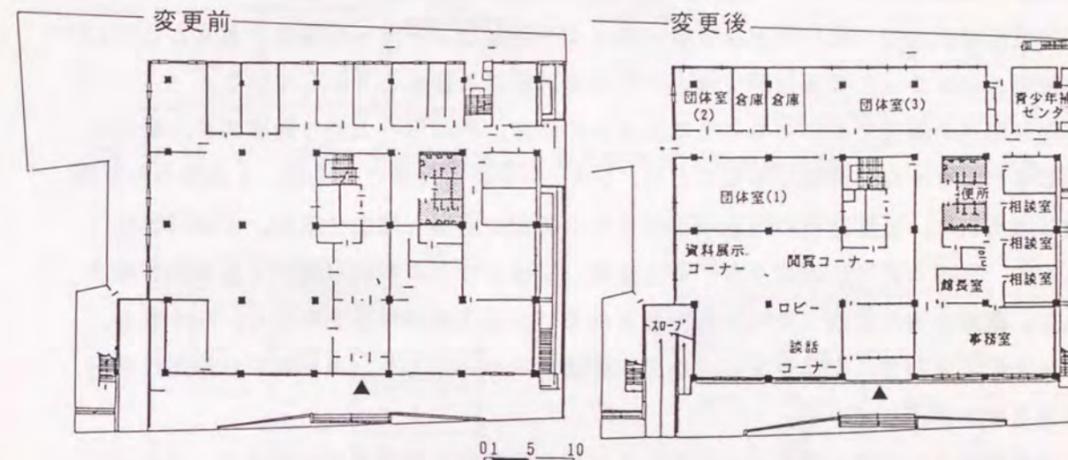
<112>前橋中央公民館(旧農業会館)1階平面図
